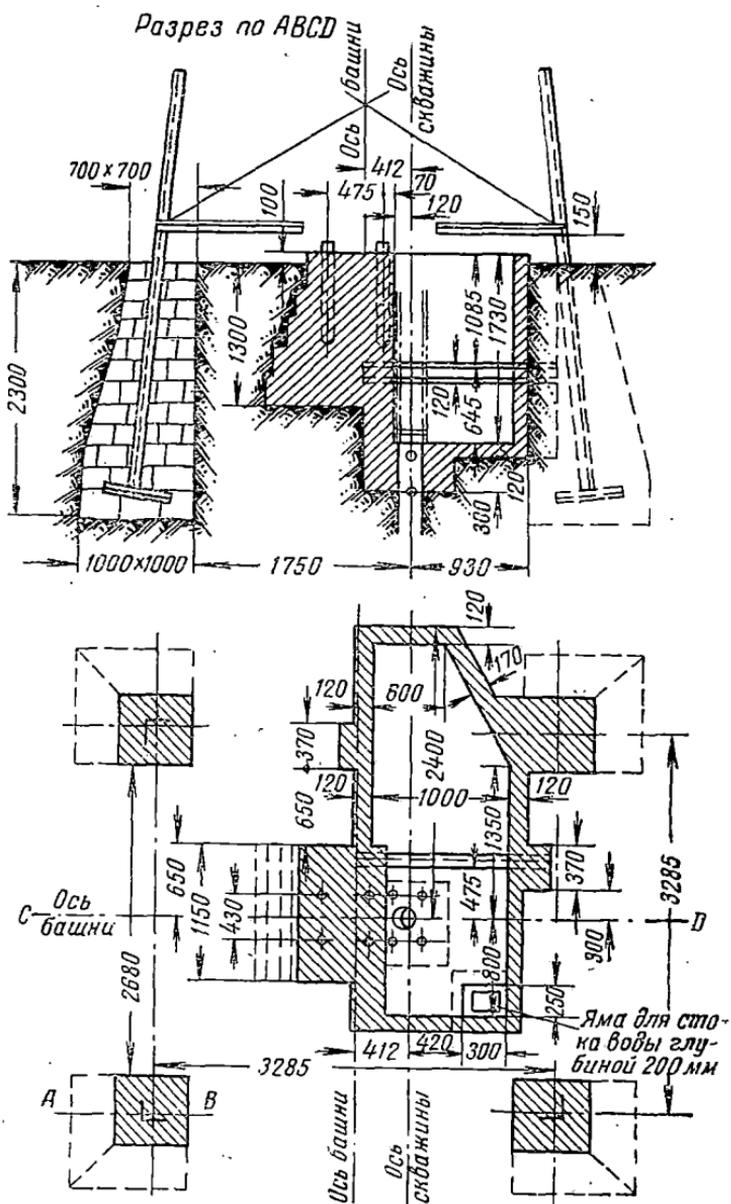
Схема разбивки площадки под шахту насоса и под фундаменты ног башни ветродвигателя ТВ-8.
